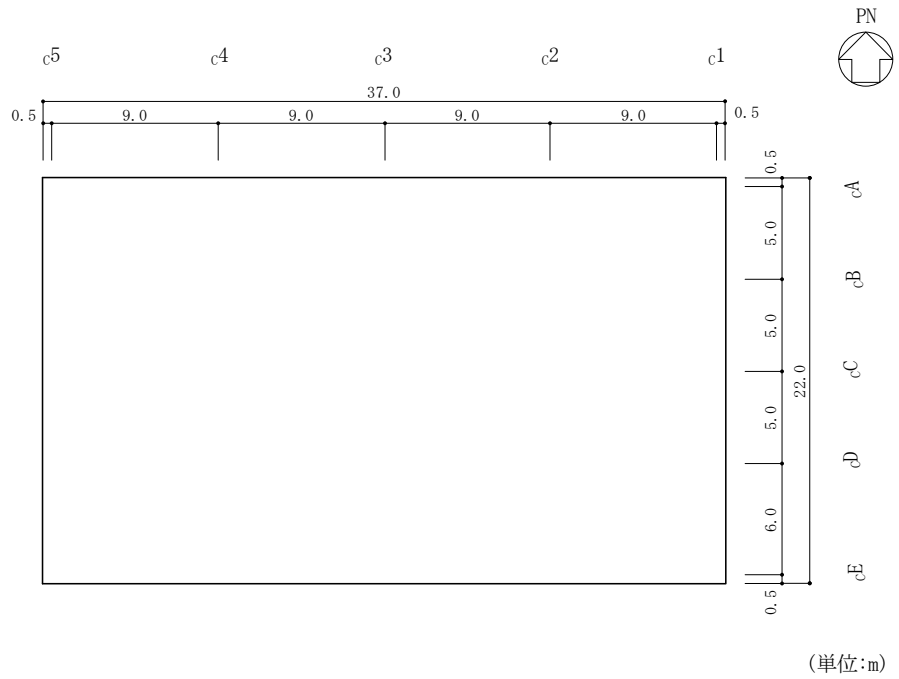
(2) 制御室建物の概略平面図 (RF, EL 22.05m)
